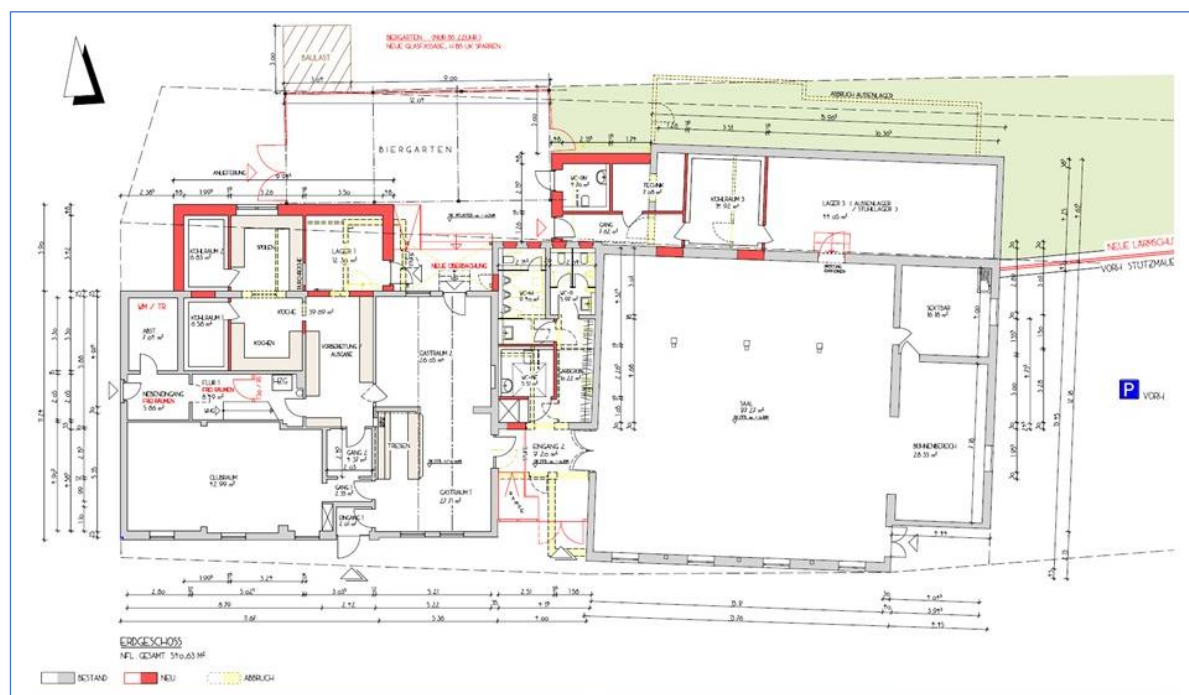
Plan der notwendigen Maßnahmen im Erdgeschoss
